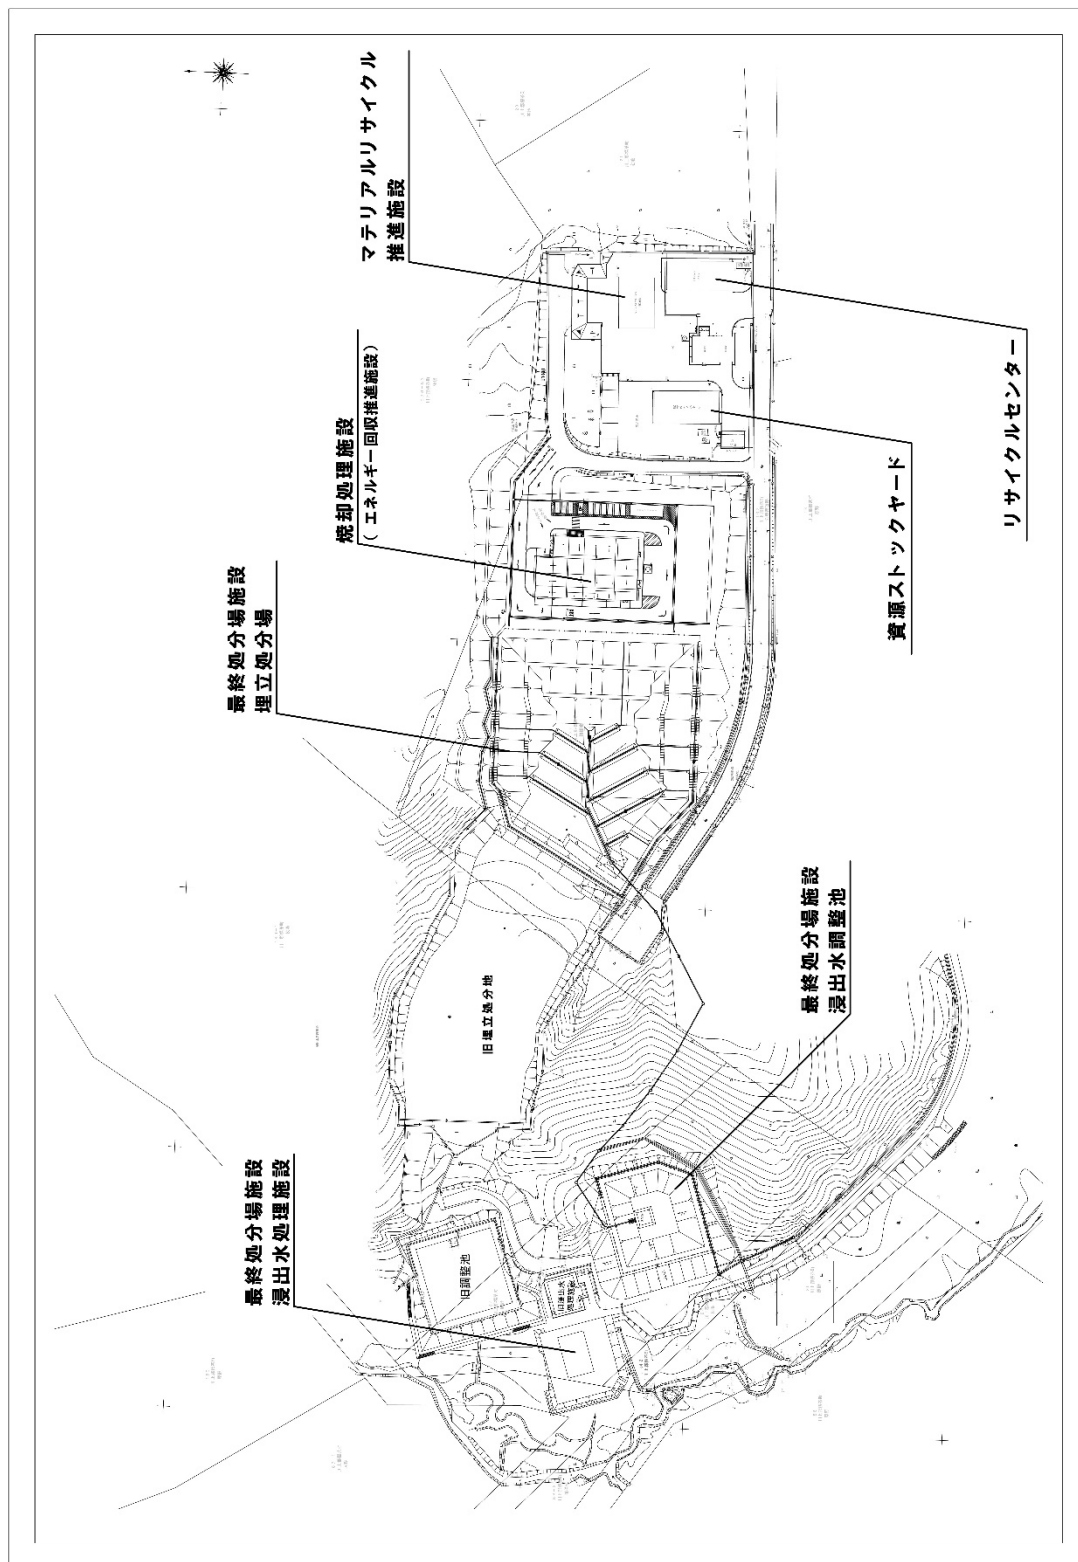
標茶町クリーンセンター配置図 (NON SCALE)
